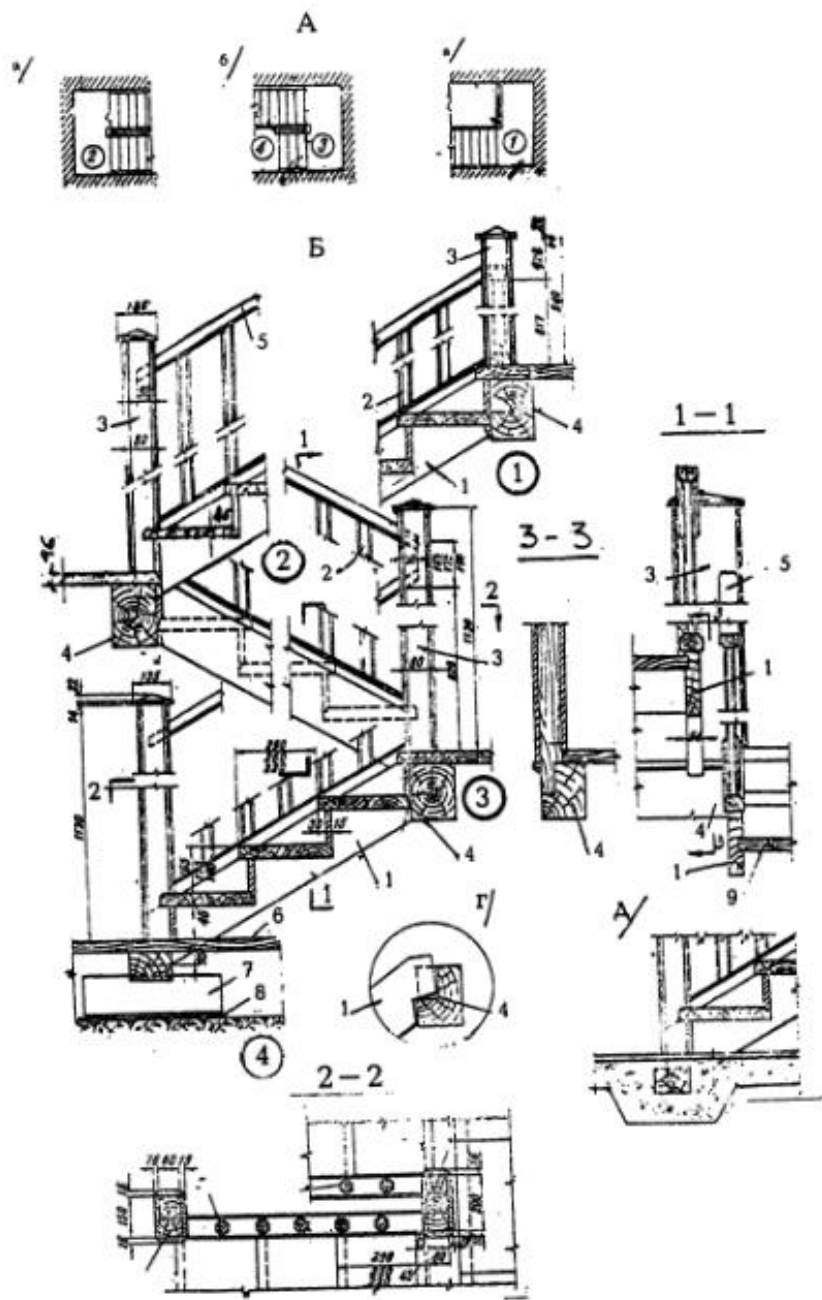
Деревянная внутриквартирная лестница: А - схемы планов лестницы в уровнях промежуточной площадки (а), нижнего (б) и верхнего (в) уровней; г - вариант нижнего опорного узла; д - опирание тетивы на балку площадки; Б - конструктивные узлы; 1 - тетива; 2 - балясник; 3 - стойка; 4 - балка площадки; 5 - поручень; 6 - дощатый пол; 7 - лежень; 8 - толь; 9 - проступь
